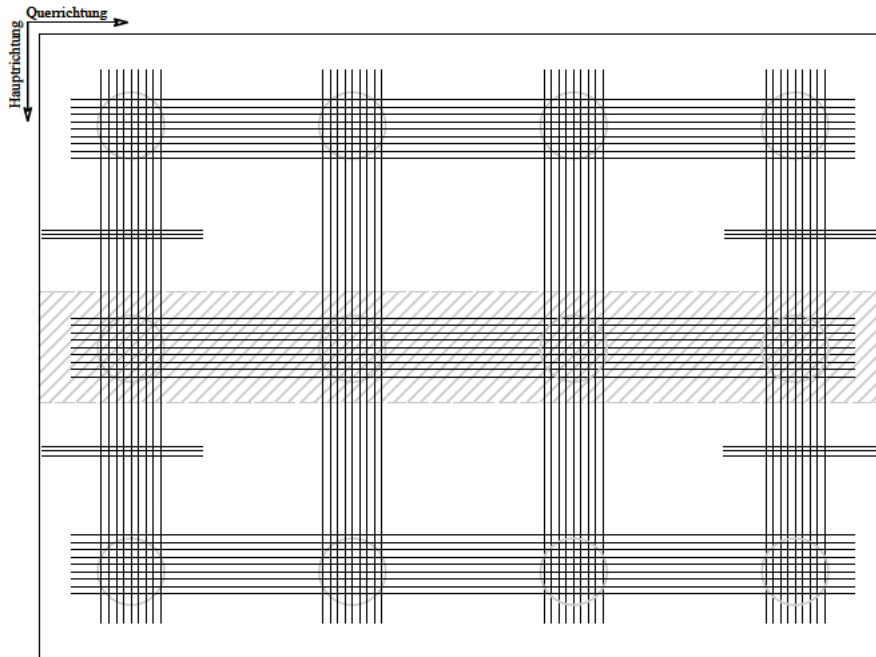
Variante 4 Lastfall 1 - Bewehrung unten
